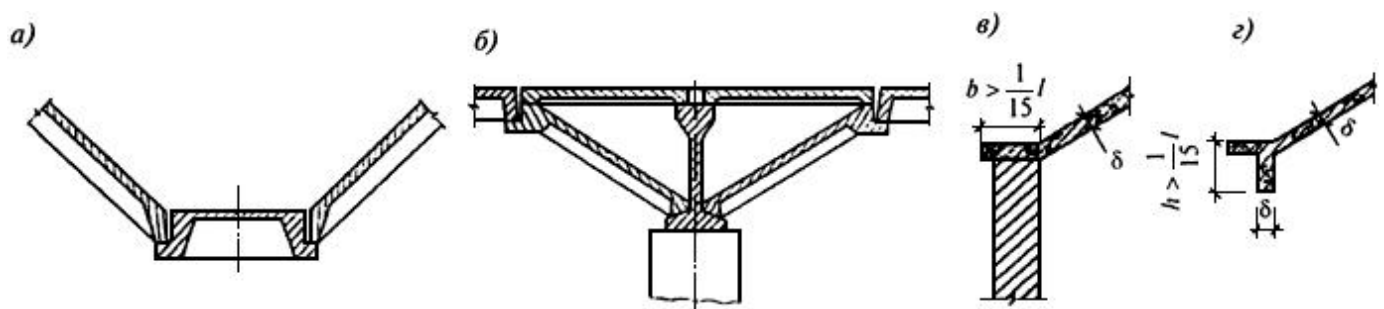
Ячейка сборного шатрового перекрытия под тяжелые нагрузки
